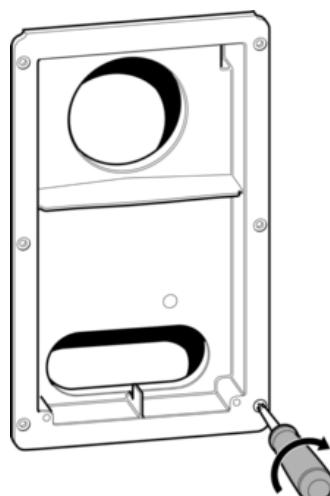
Fixation du boîtier du conduit d'évacuation des gaz
